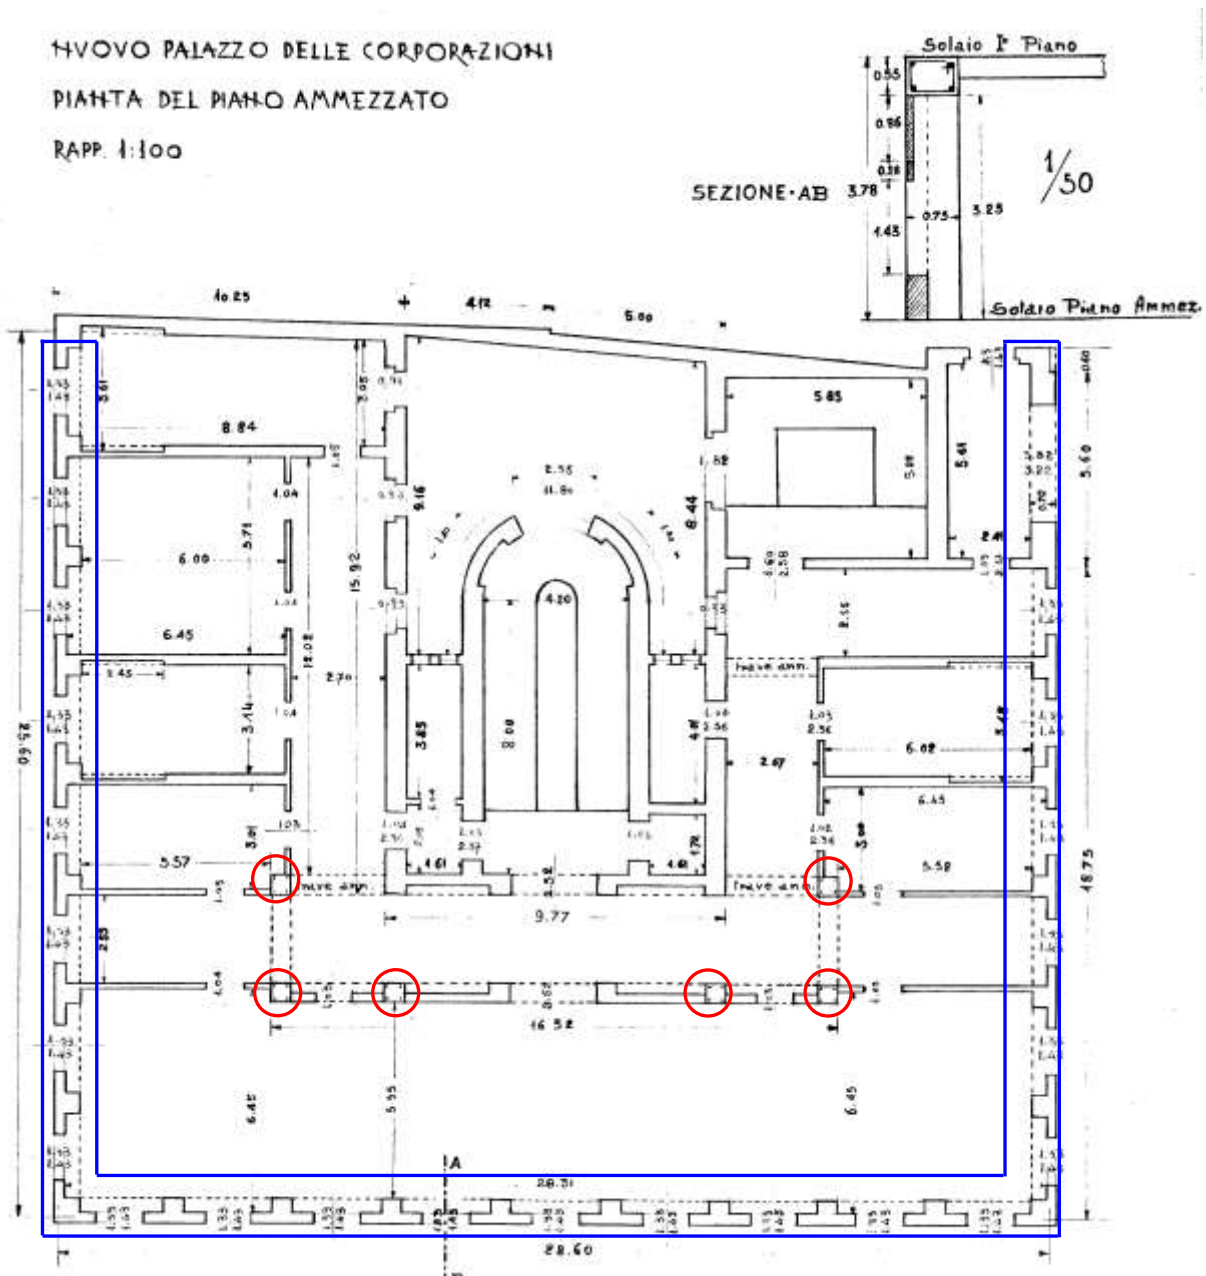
Pianta architettonica del piano primo (da progetto esecutivo del 1937, indicato come piano ammezzato negli elaborati d'epoca), con indicazione dei pilastri in c.a. (in rosso) e di quelli in muratura (in blu).
